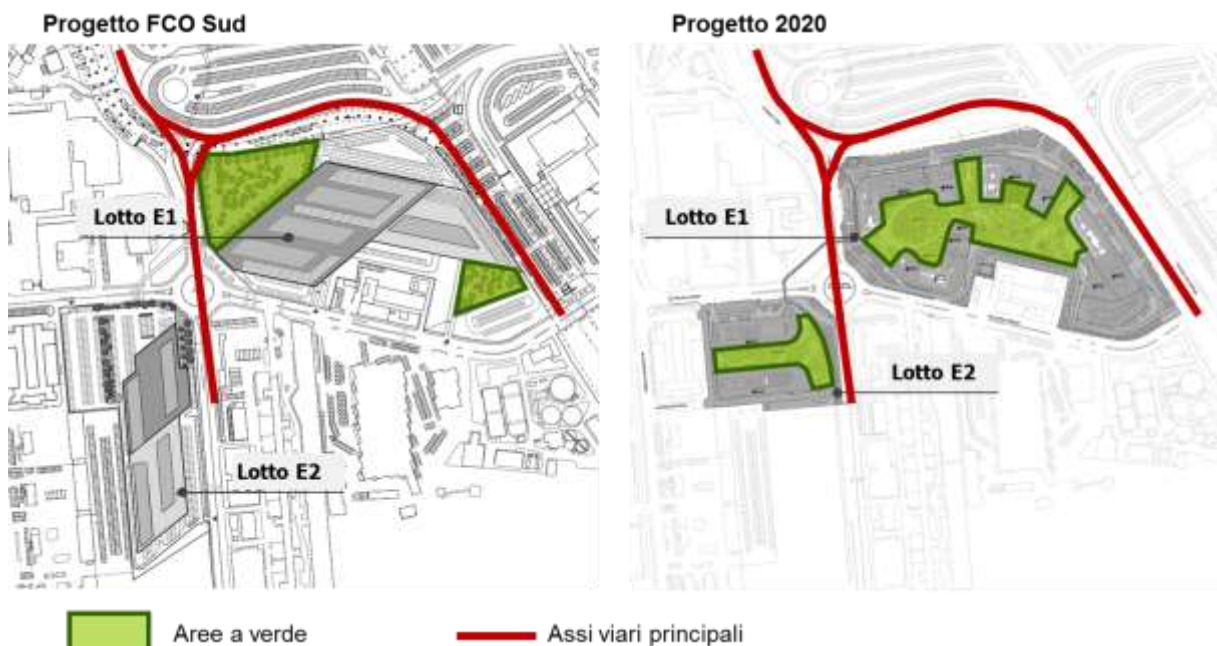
Localizzazione delle aree a verde: Raffronto Progetto FCO Sud – Progetto 2020
